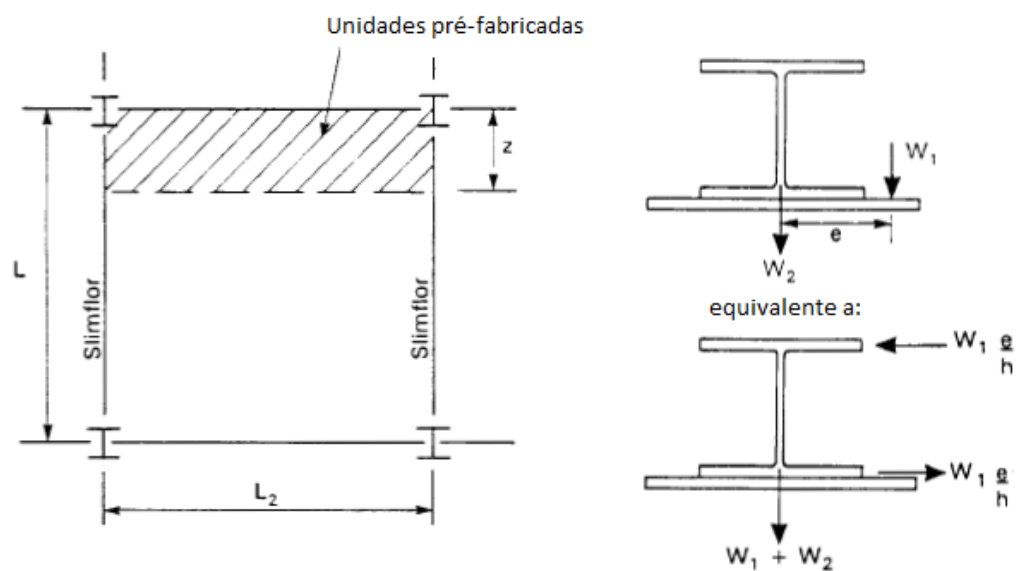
Cargas actuantes - colocação de unidades pré-fabricadas (pavimento tipo I-a) [23].
